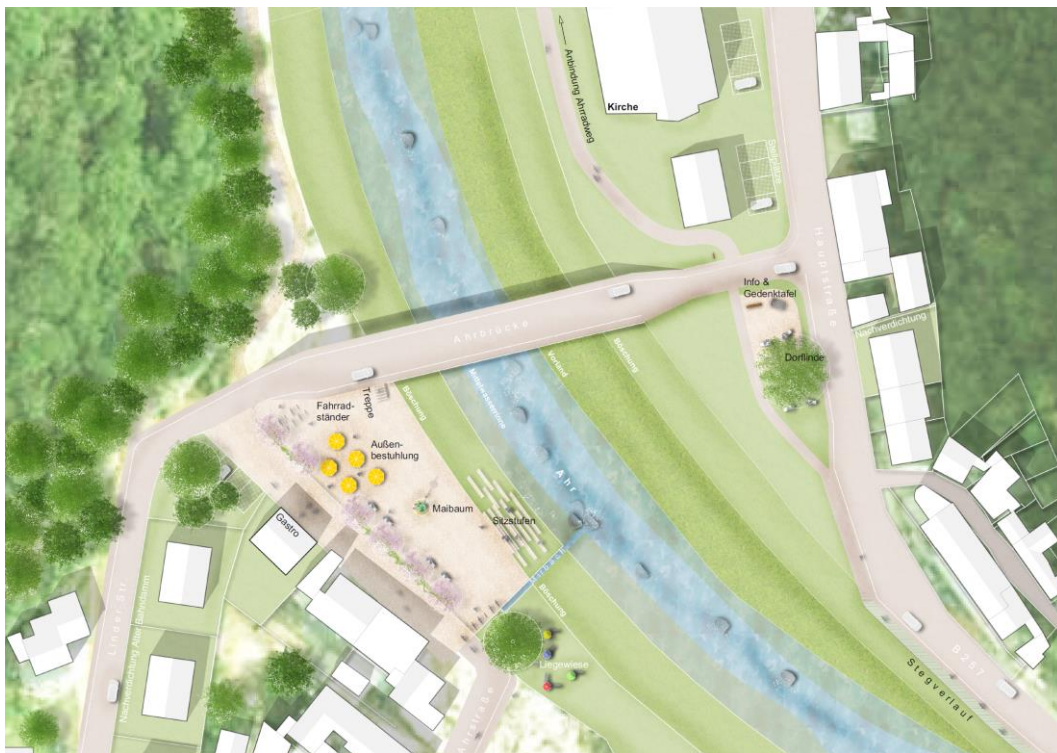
Lageplan Planung Ahrterrassen Variante 2 (i.O. 1:500)
